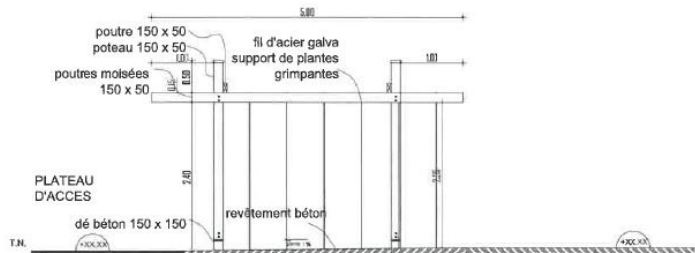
Exemple constructif (document non contractuel) dans le cas d'une construction d'une pergola
